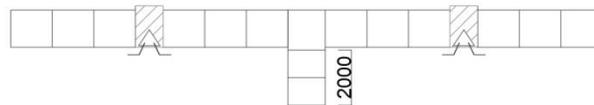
典型的 T 型双柱导架爬升式工作平台示意图(单位: mm)
